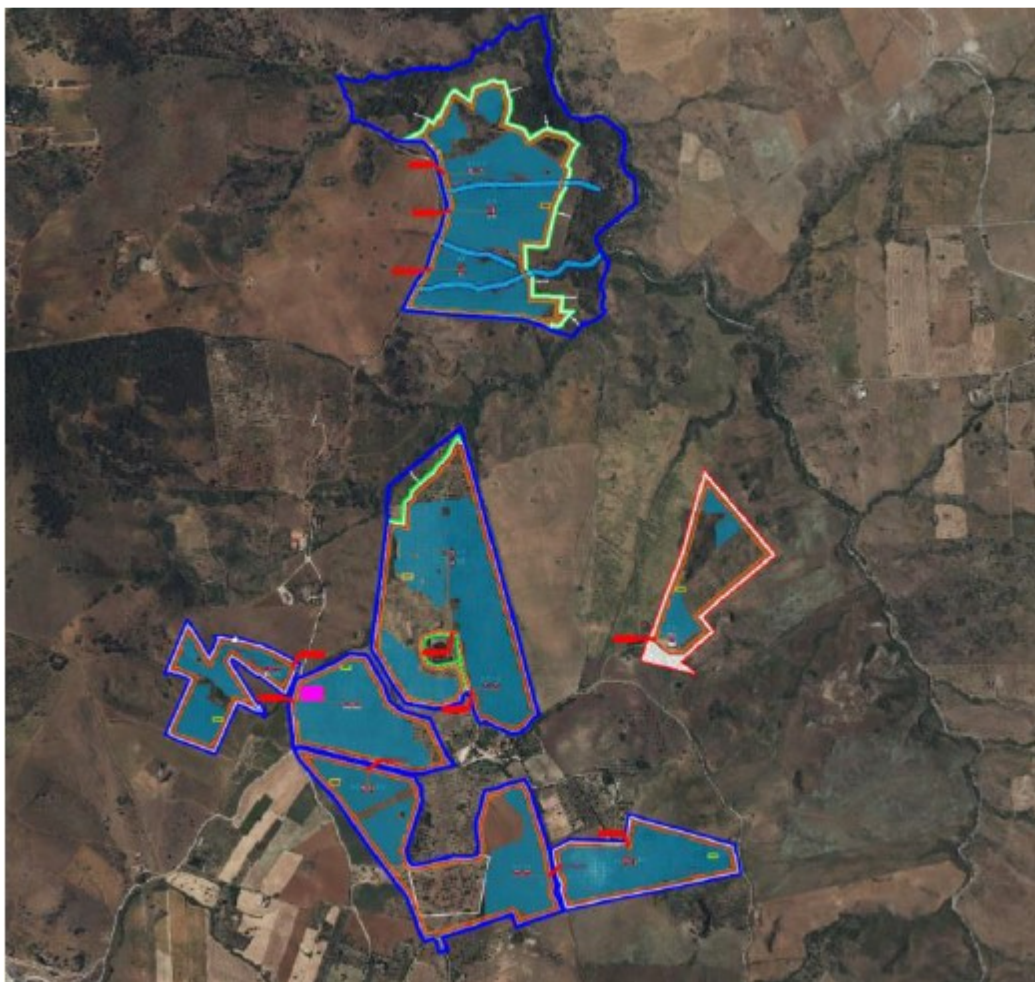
Stralcio Layout di Impianto (Progetto Definitivo)
